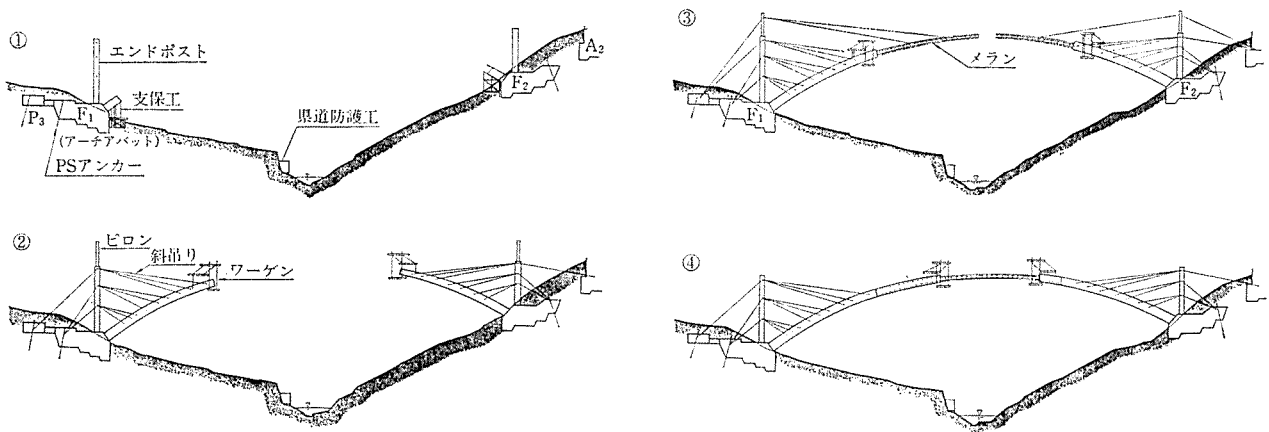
ピロン・メラン併用工法施工要領図（宇佐川橋）
